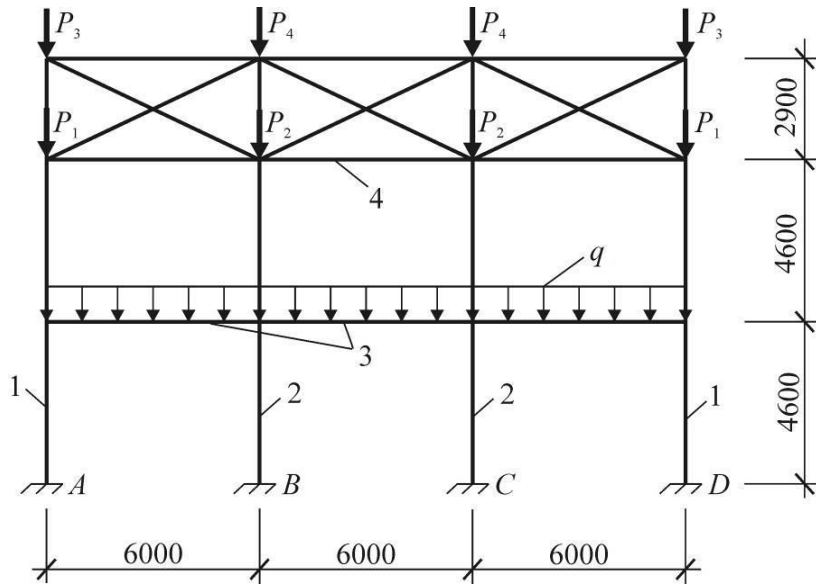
Поперечная рама: 1 – крайние стойки; 2 – средние стойки; 3 – балки перекрытия; 4 – ферма
